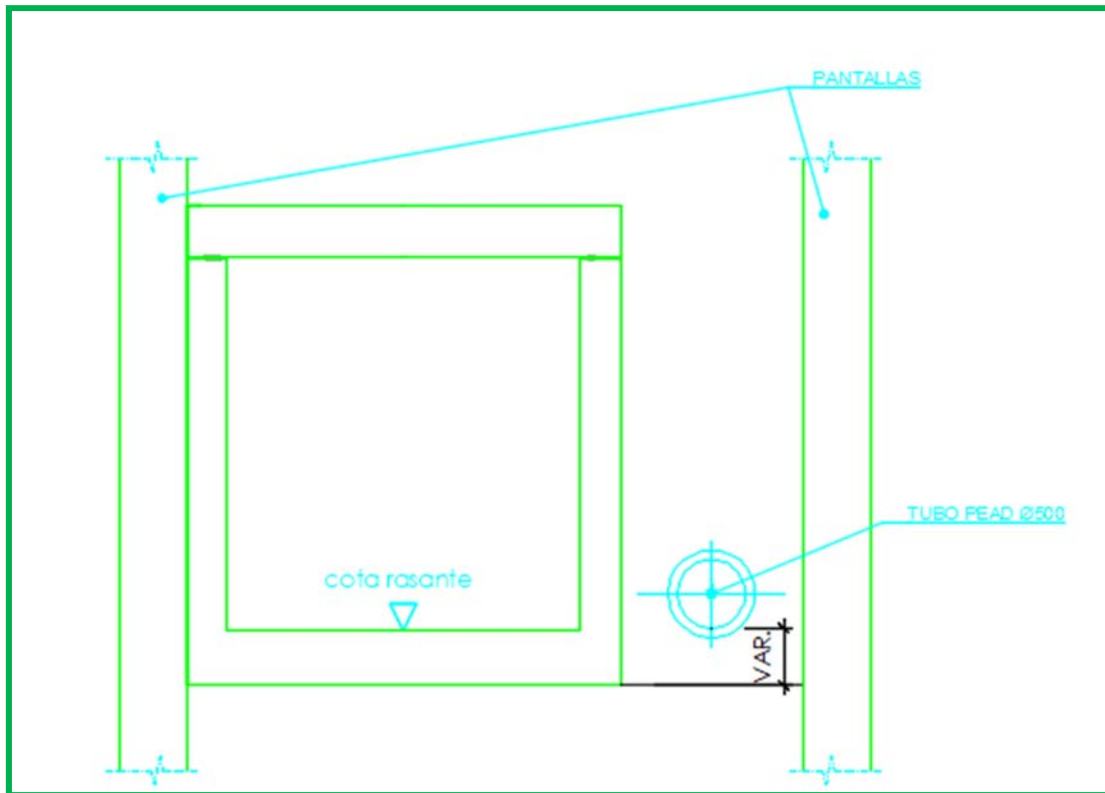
Croquis de la sección tipo del cajón a construir para realizar el desvío de la regata.
